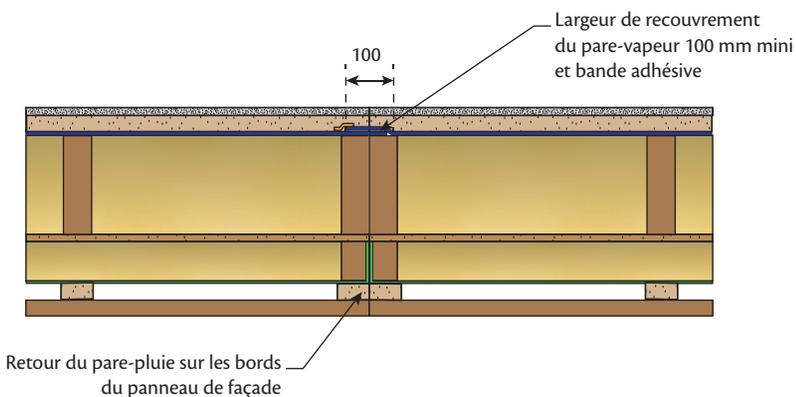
Mise en œuvre d'un pare-pluie dans le cas de panneaux préfabriqués - coupe horizontale
